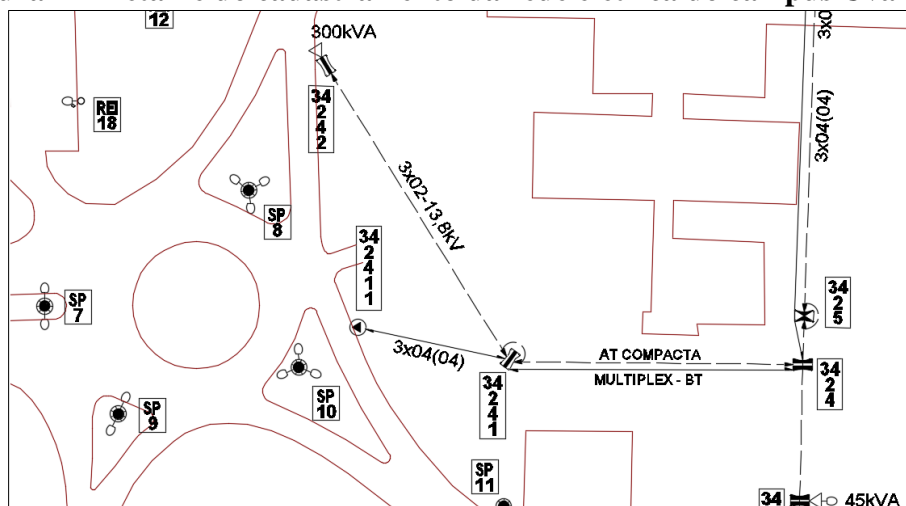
Recorte da planta cadastral da rede elétrica do campus Uvaranas
